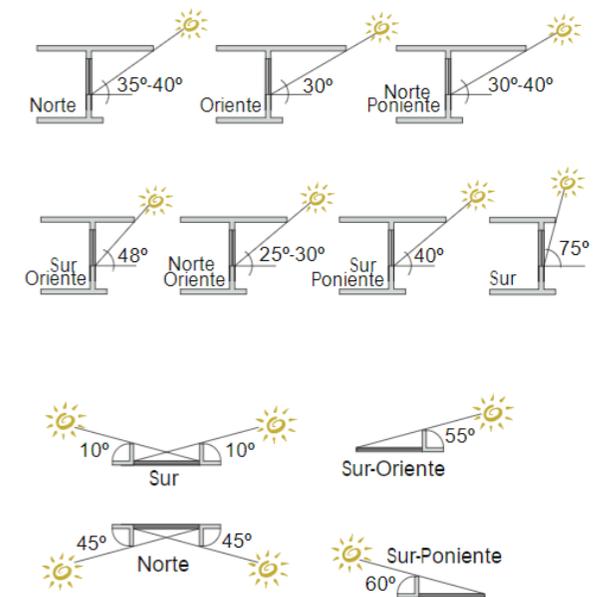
Consideraciones Unesco de angulo en fachadas, 2019.
